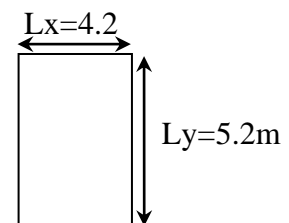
Dimensions d'un Panneau de dalle le plus sollicité
